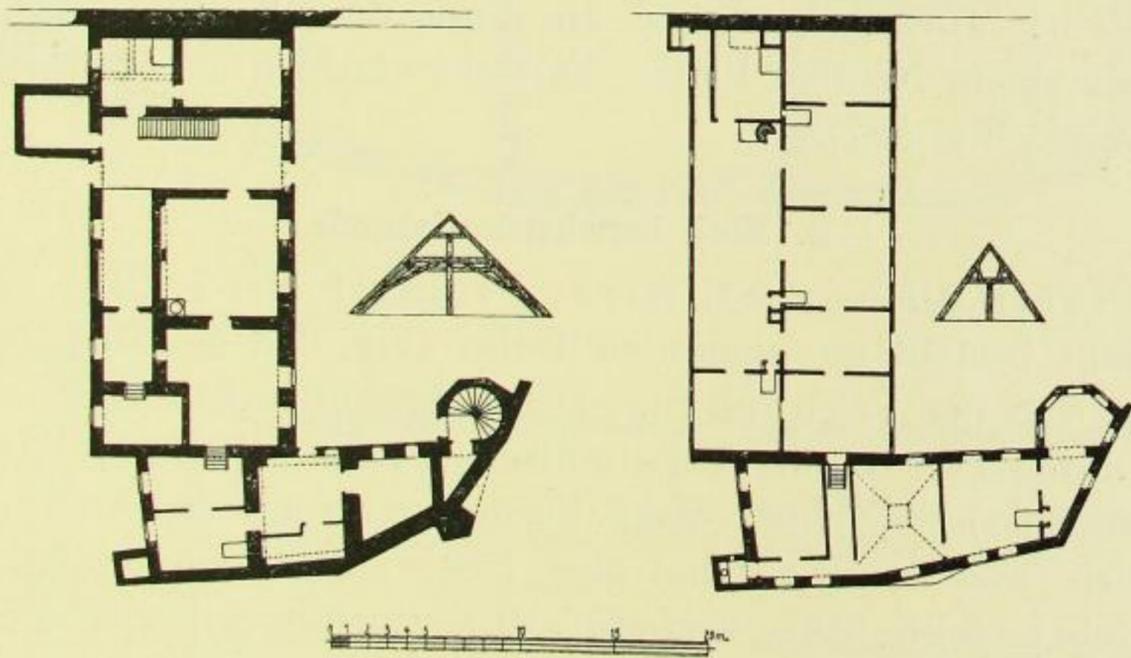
und 612. Das alte Rektorat, Grundrisse der Rektorwohnung mit den Dachbindern.
